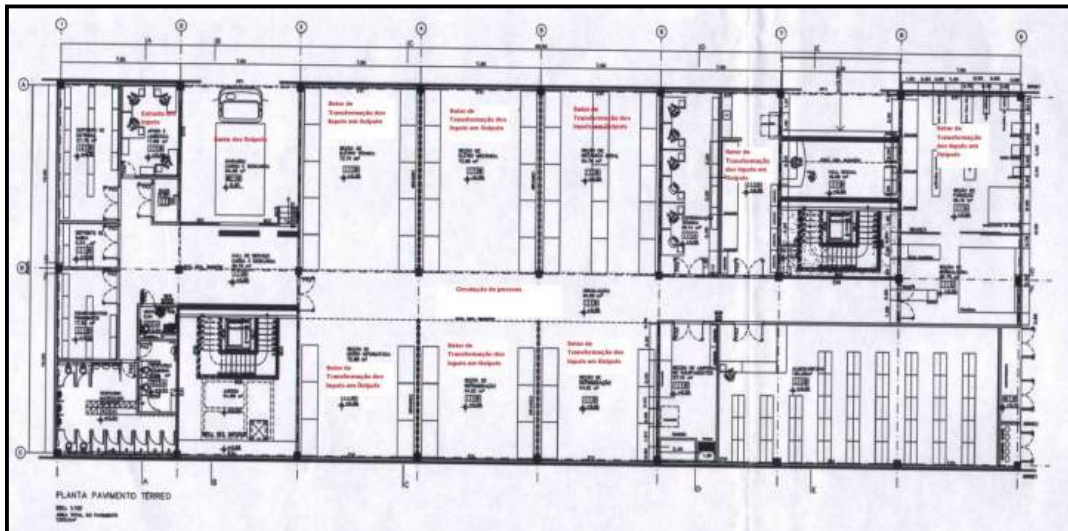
Planta em perspectiva isométrica do pavimento térreo do setor.
